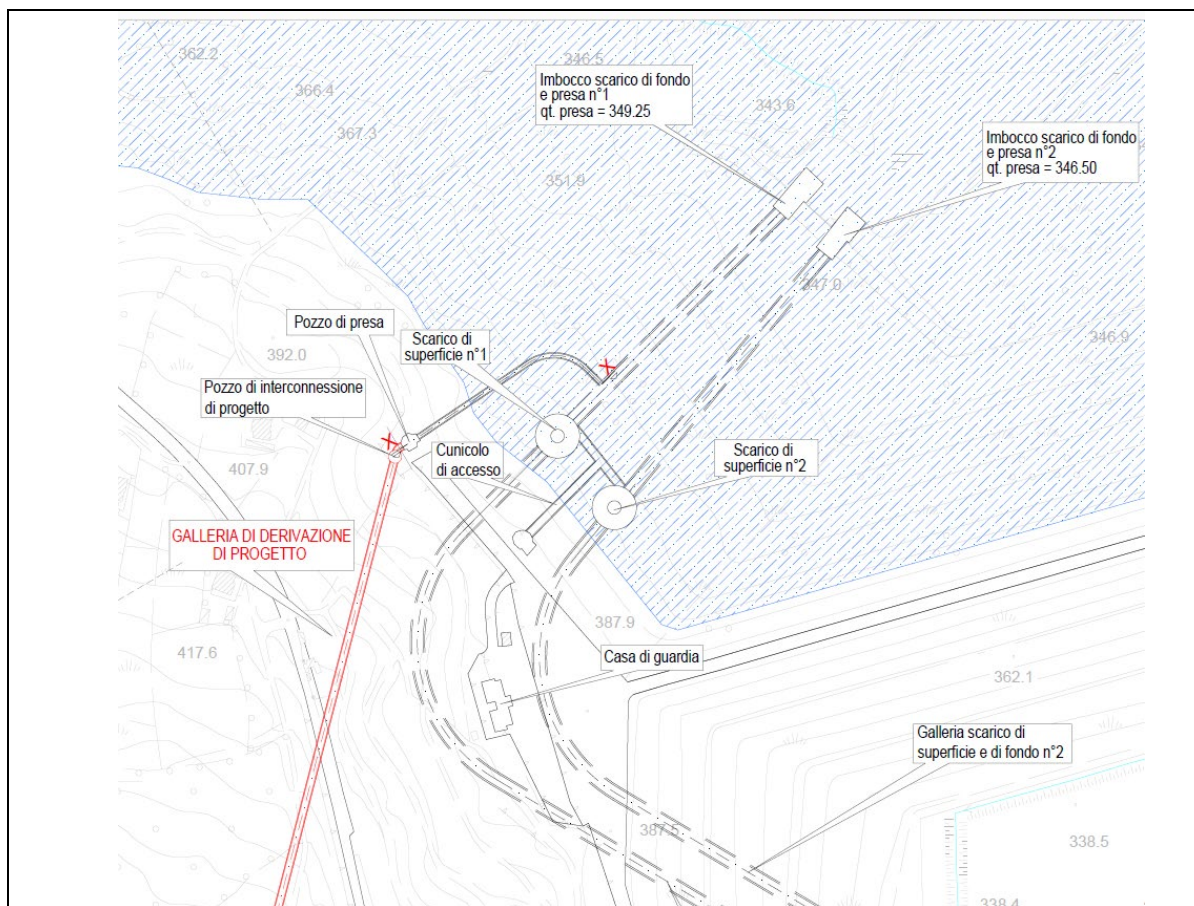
Planimetria ubicazione del pozzo di interconnessione
